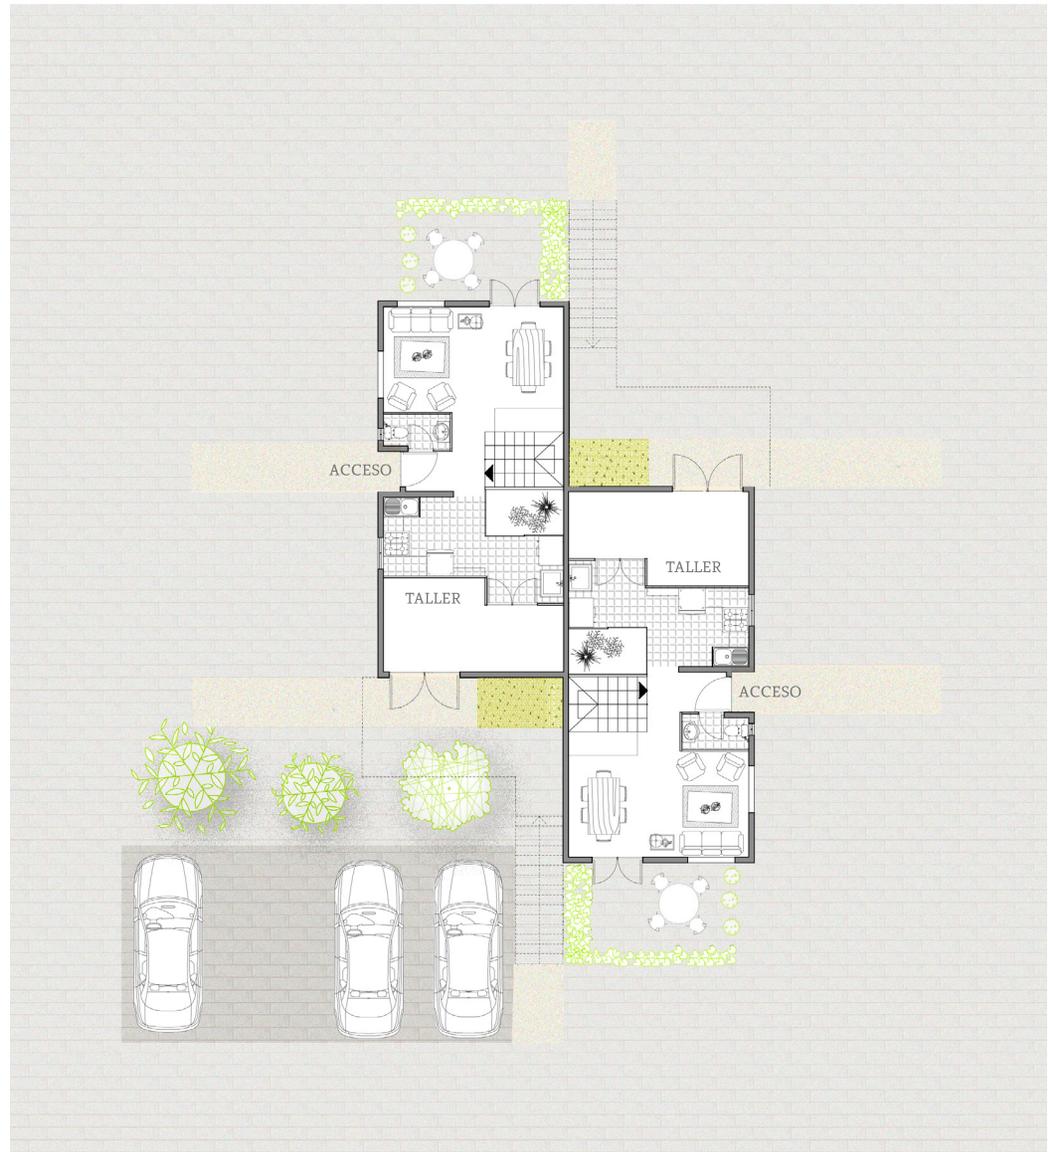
Planta propuesta unidad habitacional, primer piso, avance proyecto
